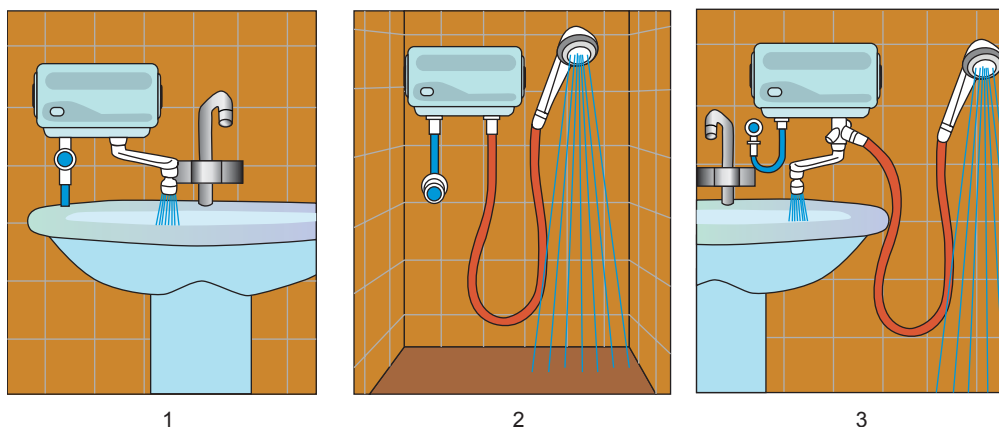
Подключение проточного водонагревателя: 1 — для кухни; 2 — для душа; 3 — совмещенный
